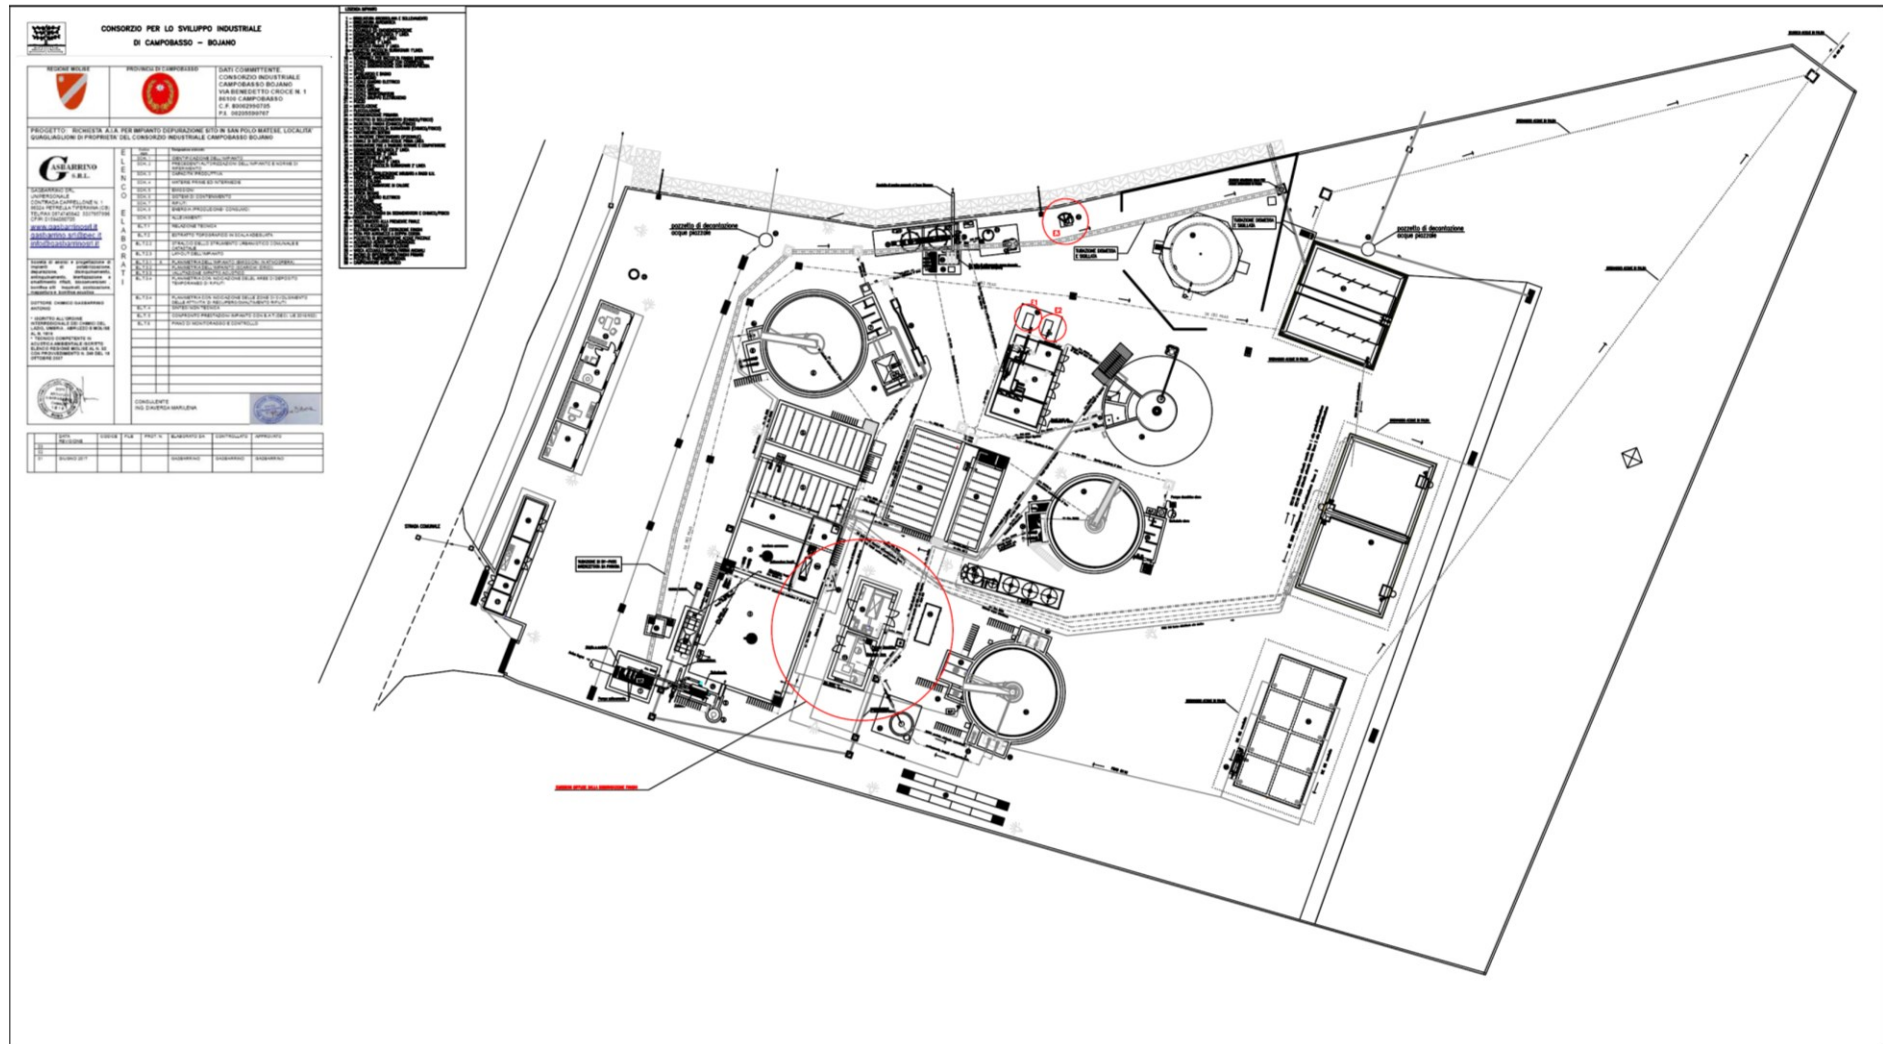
planimetria generale di stabilimento con indicazione dei punti di emissioni in atmosfera: assetto “ante operam”
